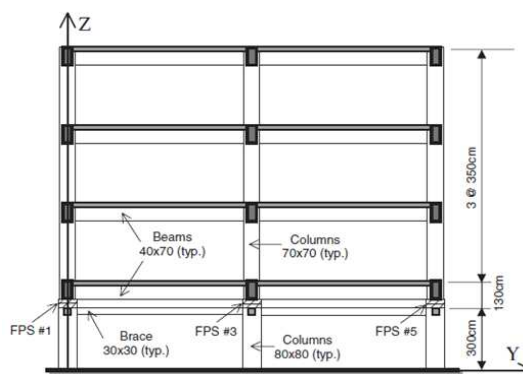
Struttura di riferimento (Sezione) (Almazan et al. 2003)
